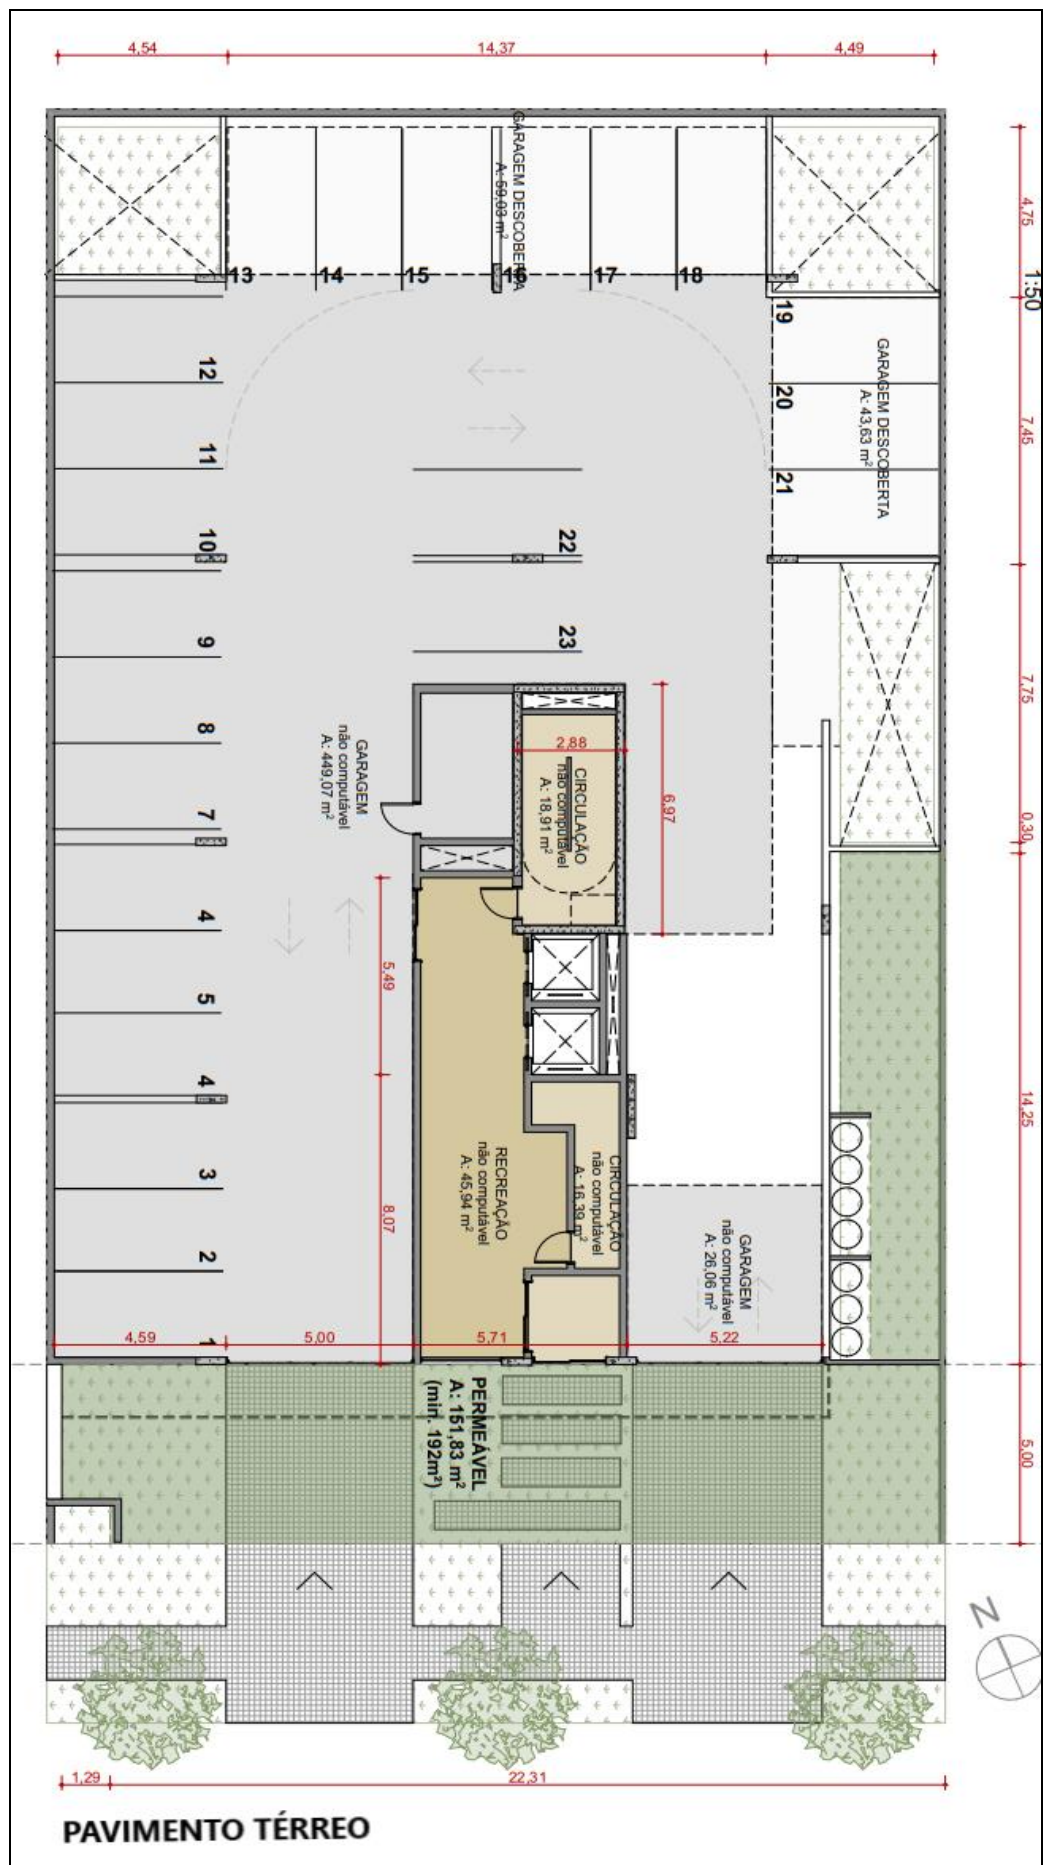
Planta do Pavimento Térreo do Condomínio Sintropia Sky Garden.
